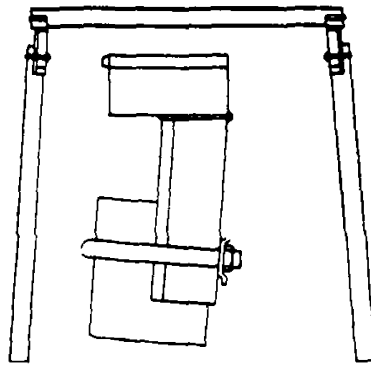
Железобетонная трапециевидная податливая крепь КМТ
